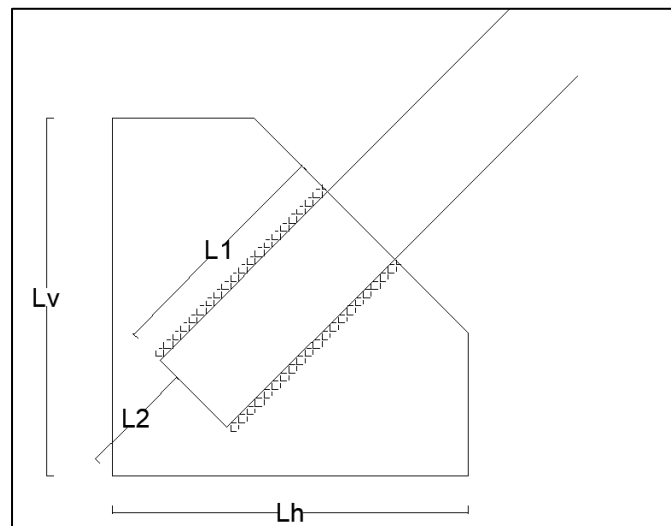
Parámetros en la soldadura entre perfil y placa
